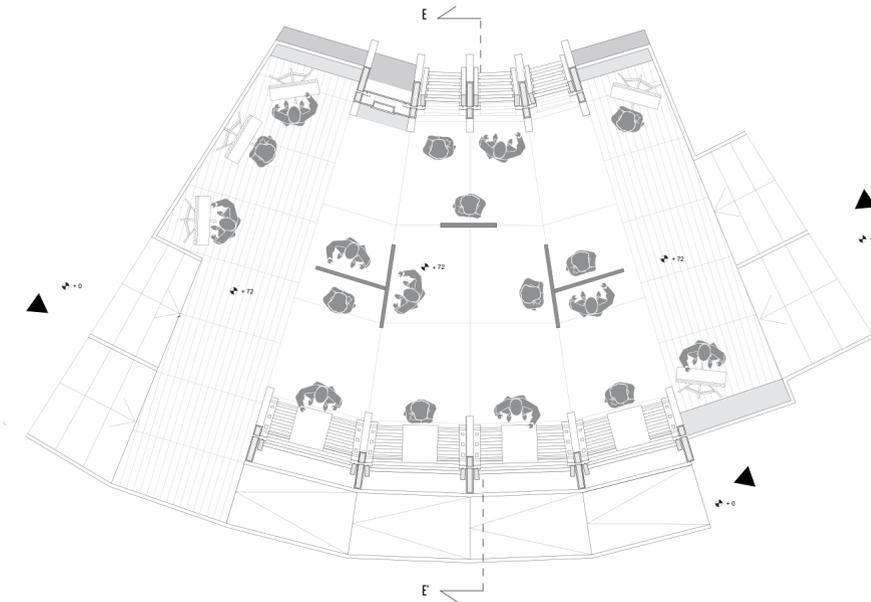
PIANTA STAND ESPOSITIVO
